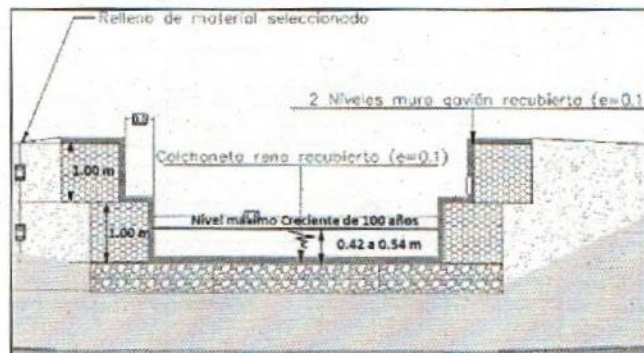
Sección transversal canalizada del arroyo Palinca, con el nivel máximo para la creyente máxima de 100 años de retorno. Tramo K0+029.19 a K0+000.
